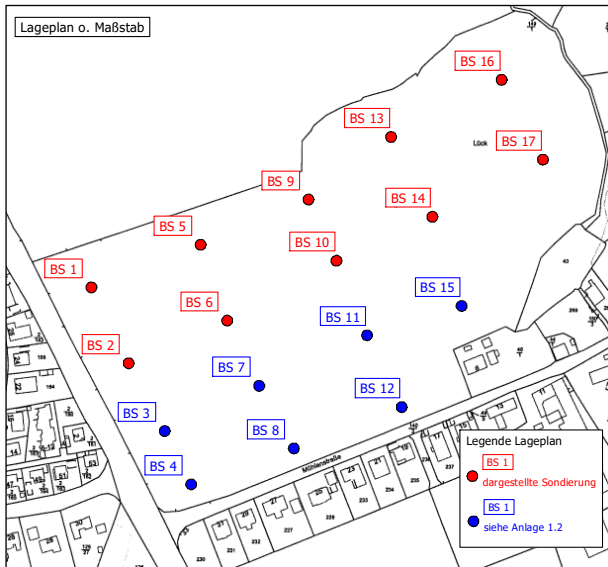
Lageplanausschnitt s. Anl. 1.1 (o. M.)
